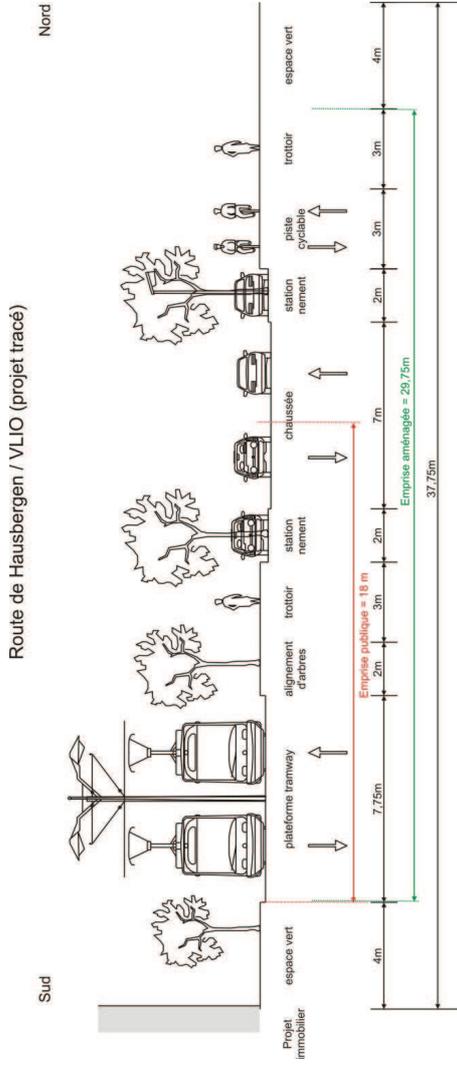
Situation projetée (coupe 13) sur la route de Hausbergen
